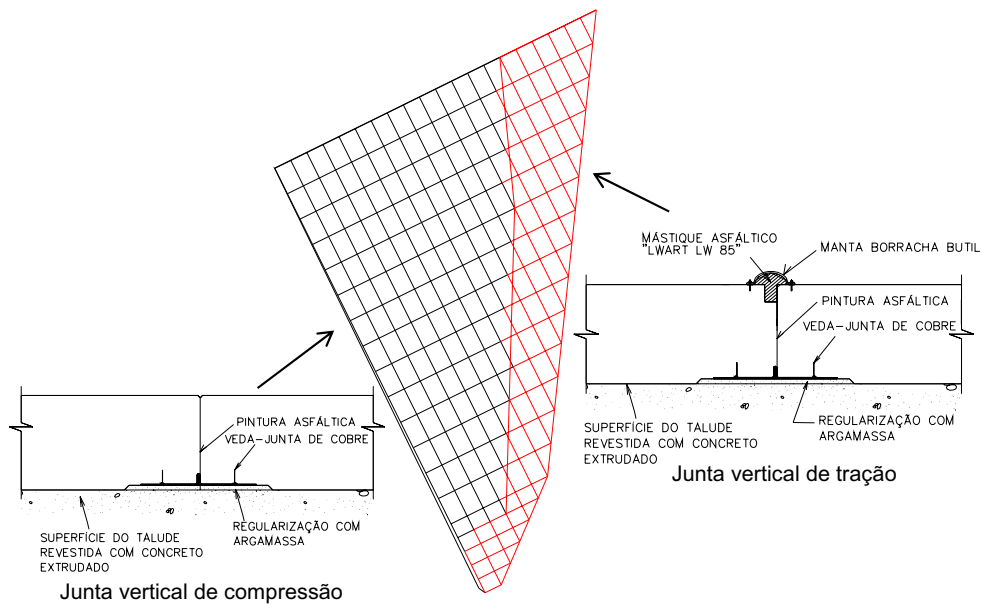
Posicionamento das juntas verticais entre os painéis da face de concreto.
